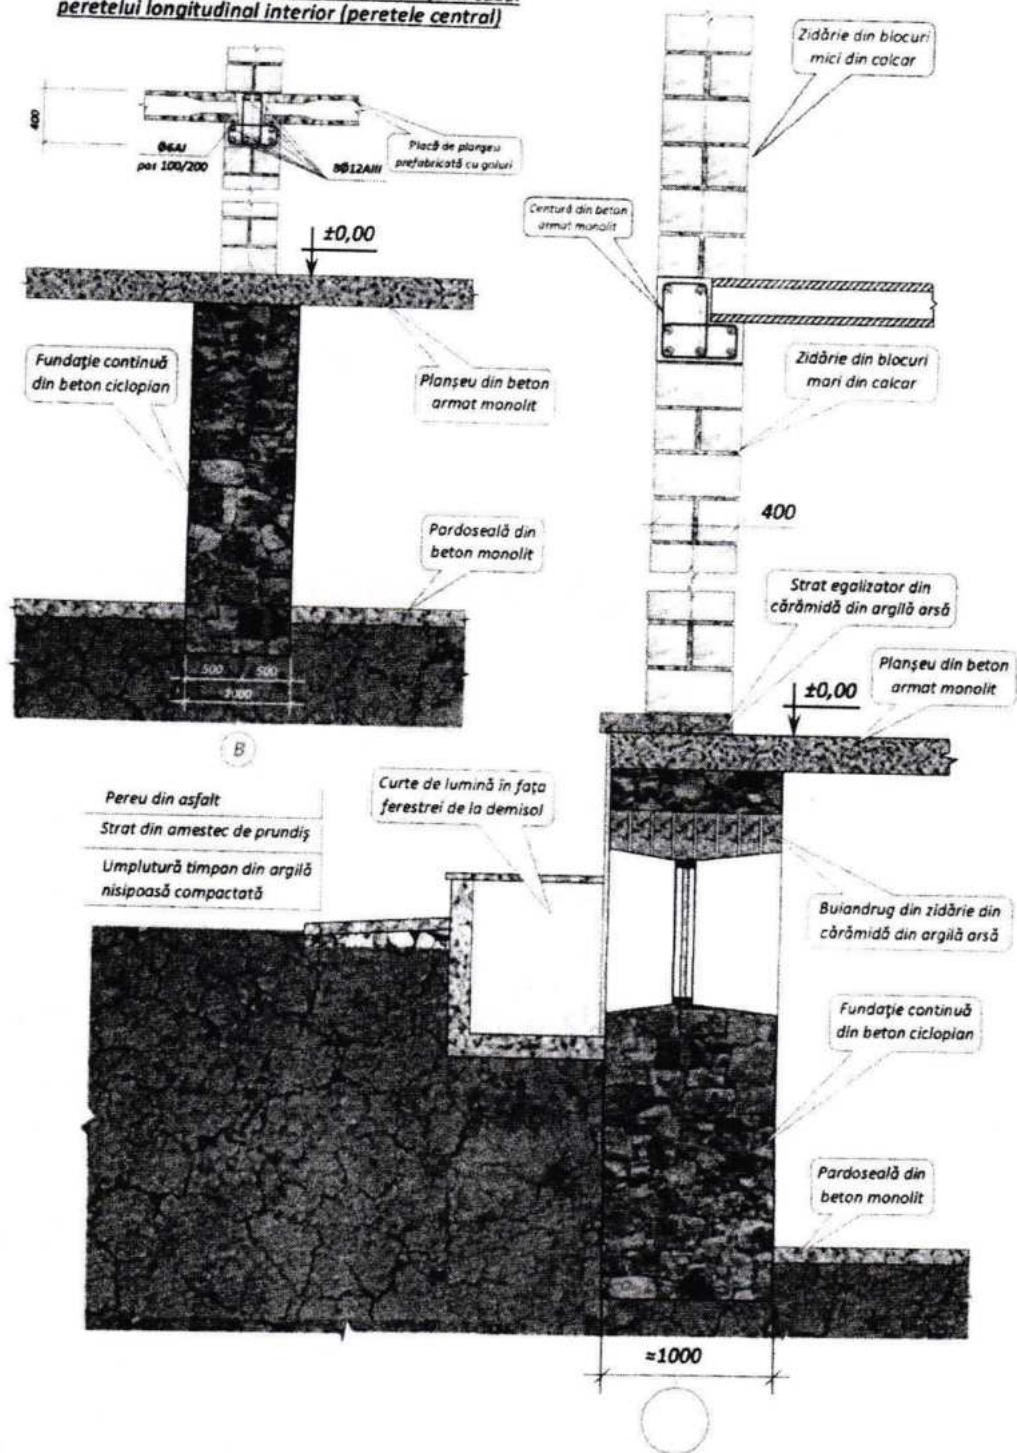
Scheme constructive a fundației continue, pereților structurali și planșeului
